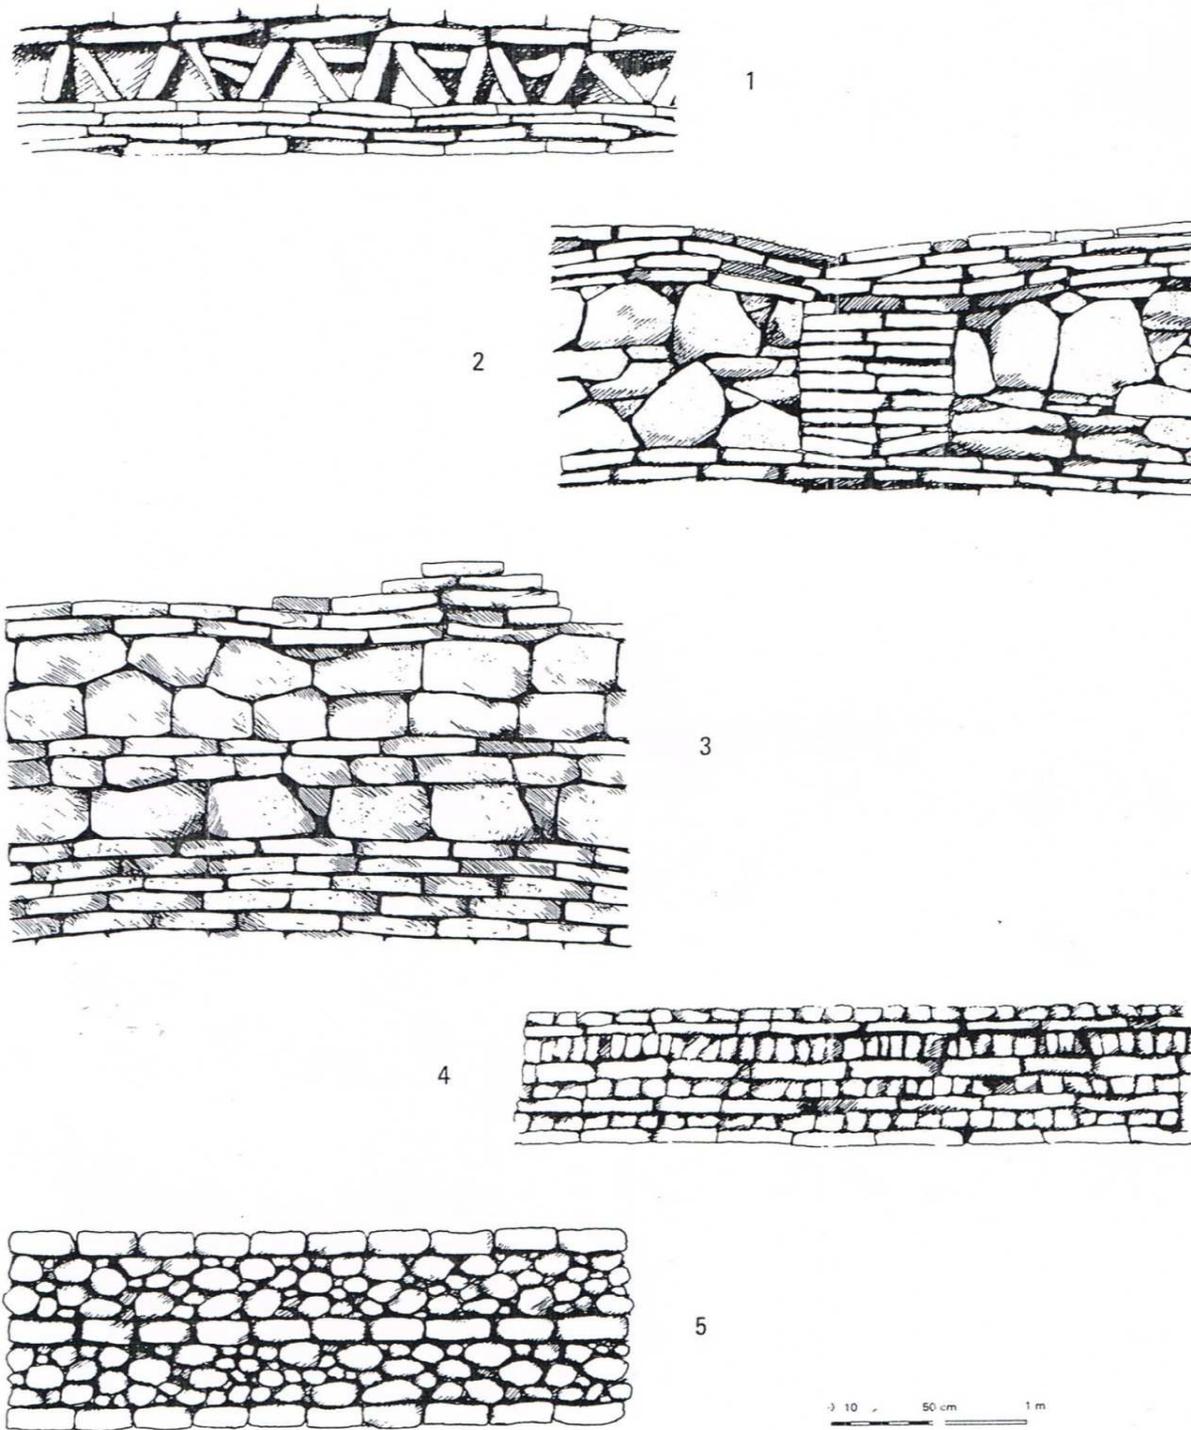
Modes divers d’assemblage de briques et de pierres dans la construction. 1 – Disposition particulière de briques au sommet de la tour (Michel Dufour). 2 et 3 – Utilisation conjuguée de briques et de pierres dans la muraille d’enceinte (M. D.). 4 – Disposition habituelle de l’appareillage de briques (M. D.). 5 – Association de briques posées à plat et de pierres liées par un ciment sableux, au sommet de la plate-forme soutenant la tour.
